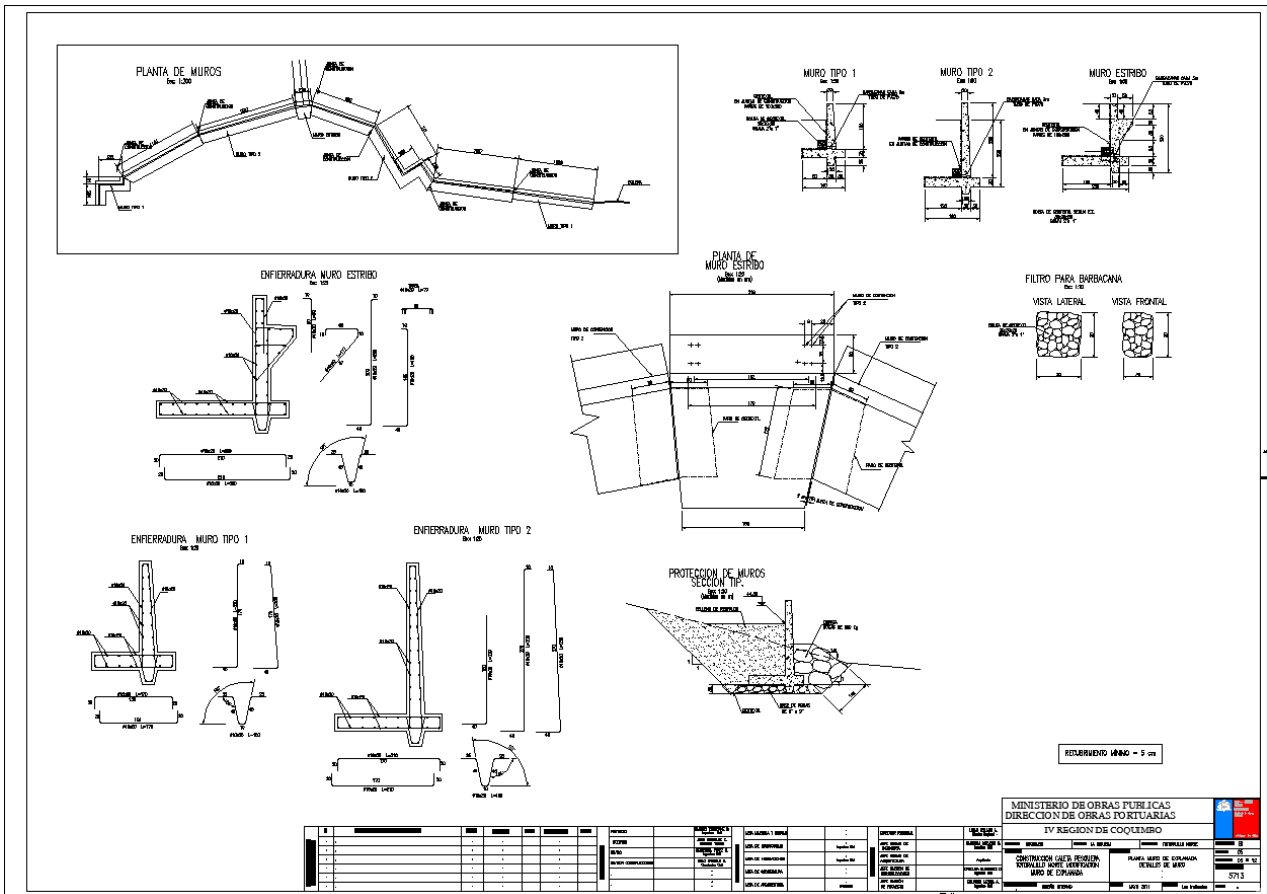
Planta muro explanada y detalles muro, Planos de modificación de muro explanada 2011.
